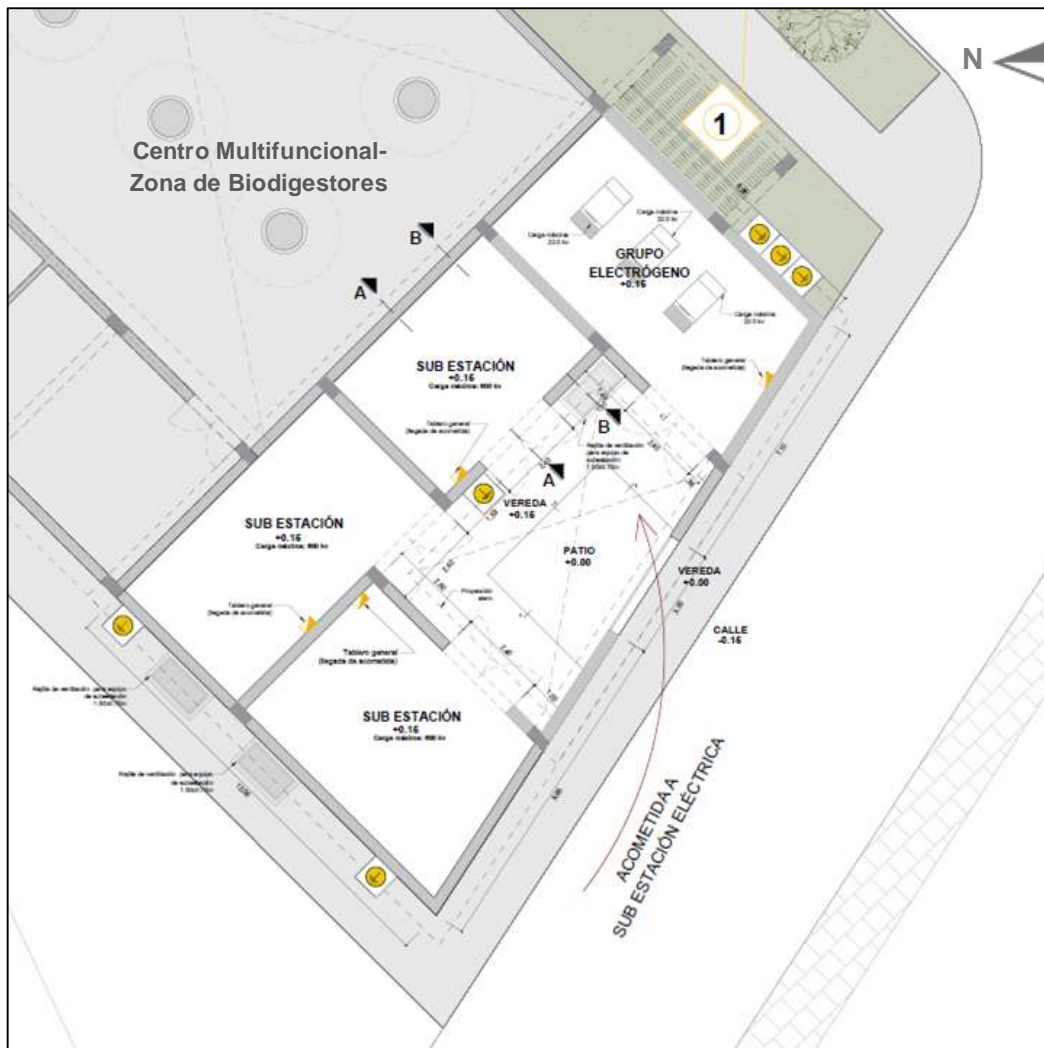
Planta del grupo electrógeno y de la subestación eléctrica
